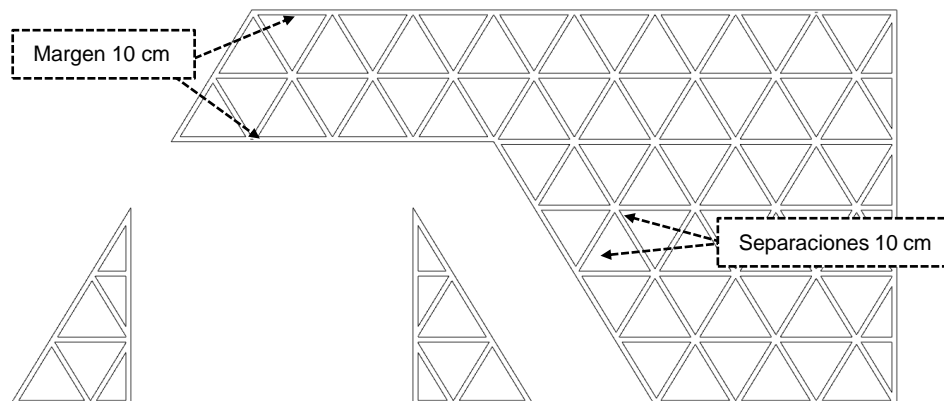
Estructura Interna, Malla 2, Muro Acristalado, Fase 2
